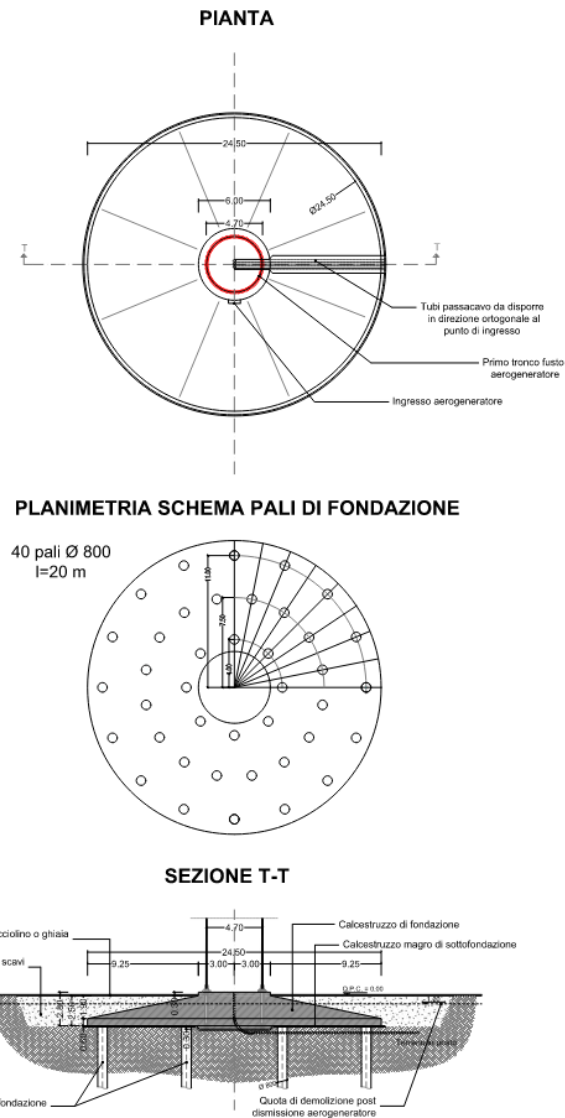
Schema costruttivo eventuale fondazione su pali
